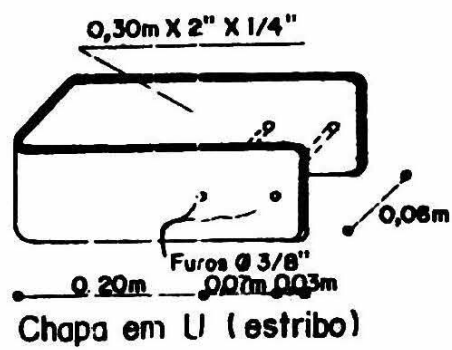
Chapas de ferro e braçadeira para vigeamento.
